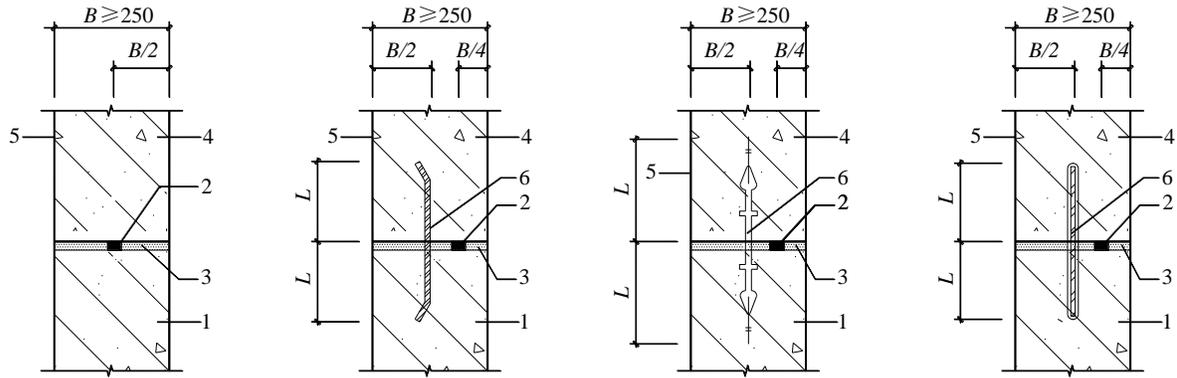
遇水膨胀止水条（胶）施工缝防水构造
